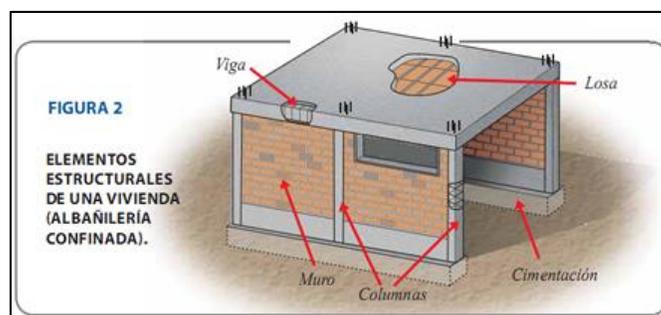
Esquema de una vivienda con sus elementos estructurales principales.
